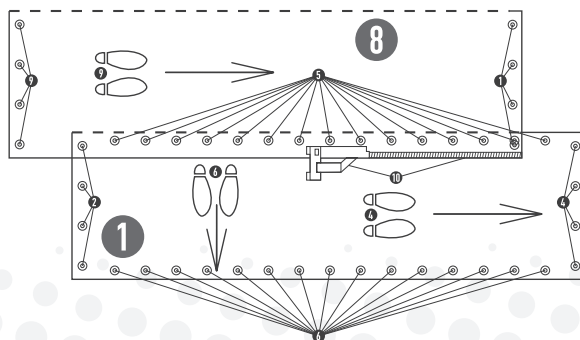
Последовательность проведения работ по устройству гидроизоляции при механическом способе крепления
